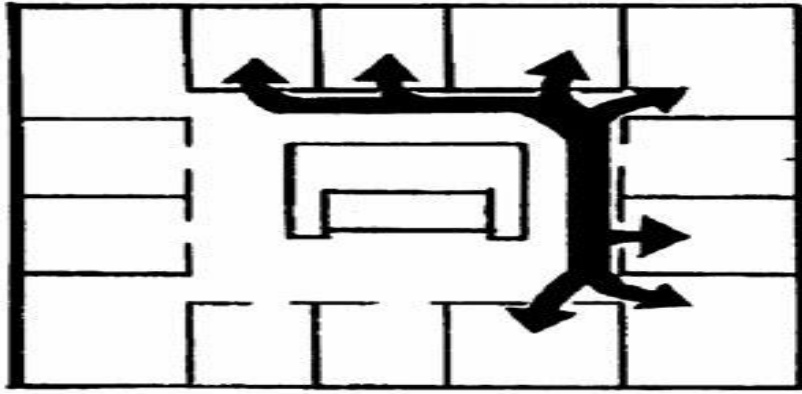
типовий план поверху будівлі каркасного будинку з важкими стінами.
